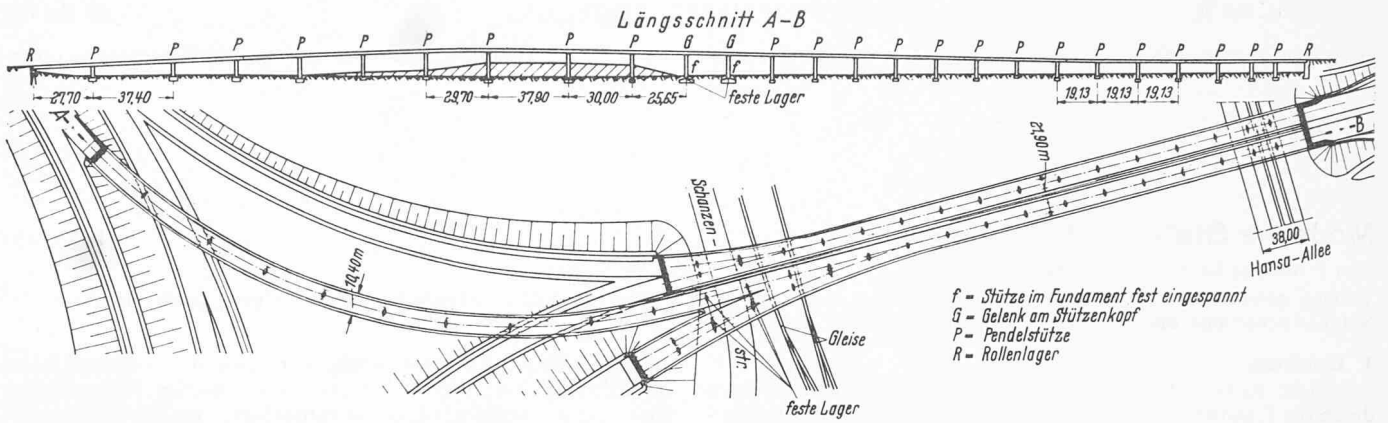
Grundriss einer verzweigten Hochstrassenbrücke mit kontinuierlichen Trägern über 34 Öffnungen hinweg (Prinzenallee, Düsseldorf)
